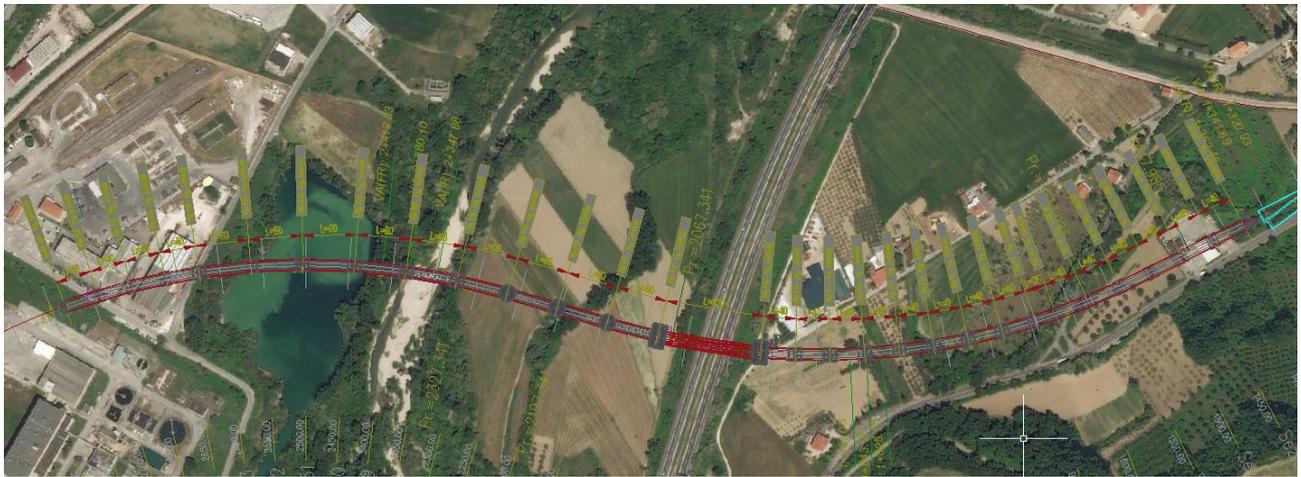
VI21 – Posizionamento su ortofoto rispetto alla linea esistente
